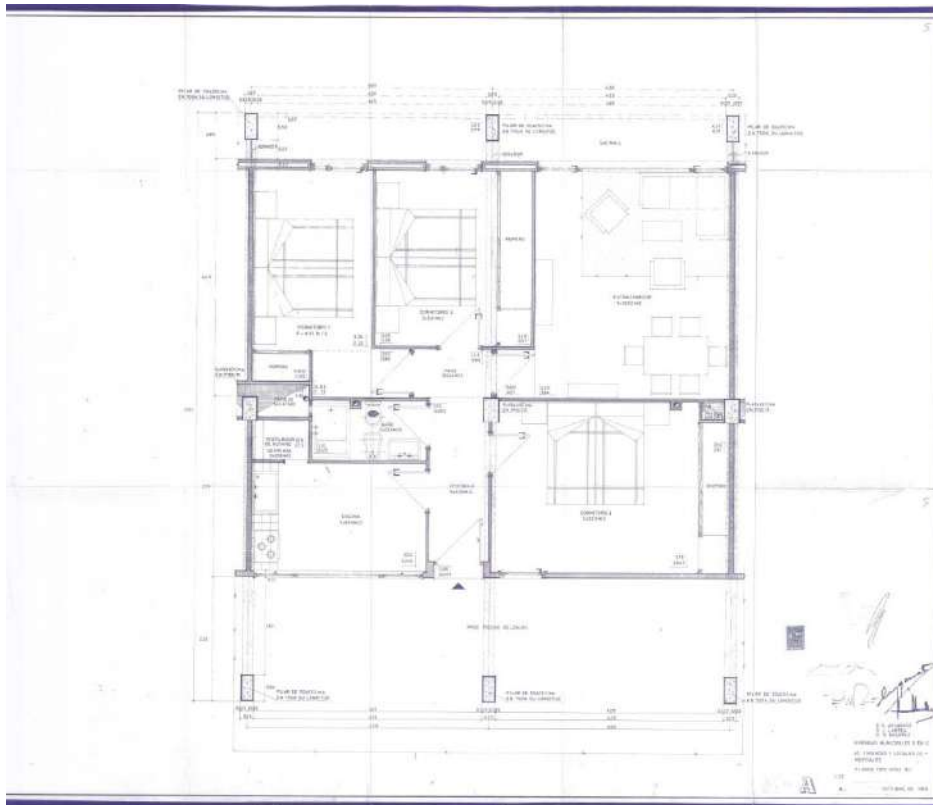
Planta del apartamento de planta única. Fuente: Proyecto para viviendas y locales comerciales, Grupo Pedro Astigarraga. Archivo Municipal de Bilbao, 63-5-313.
